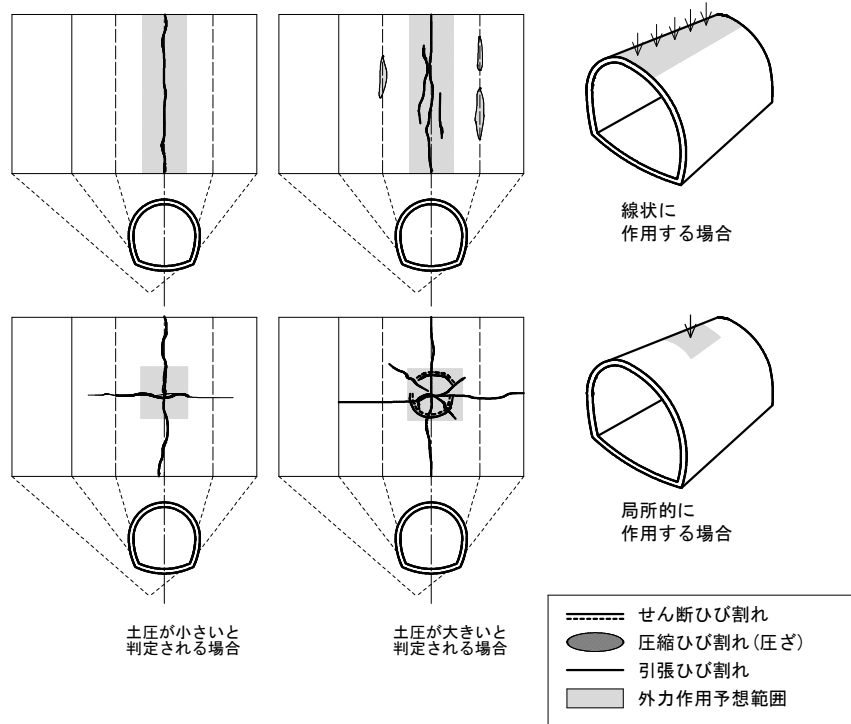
緩み圧によるひび割れパターン図
